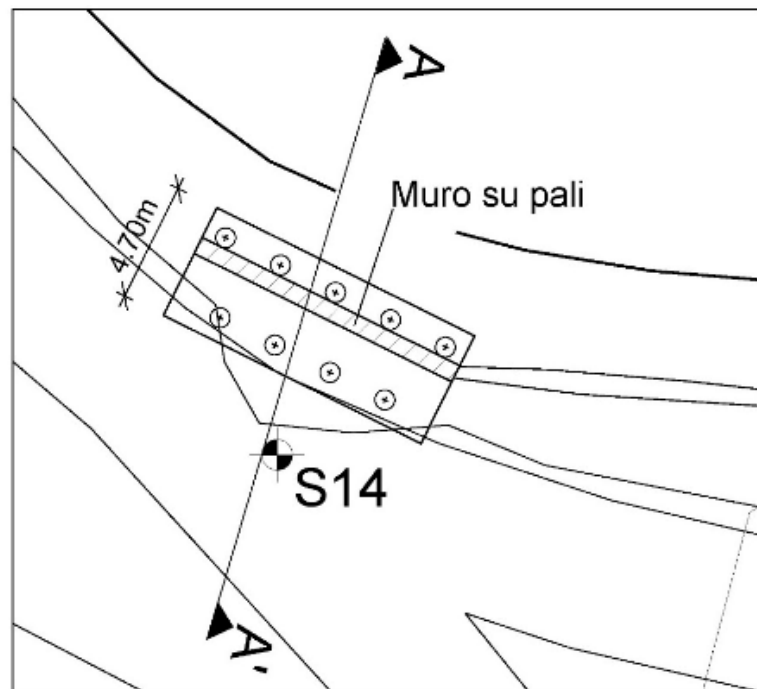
Zona Pietralunga, km 8+700. Planimetria schematica con indicazione del muro su pali. Il rilievo topografico è stato eseguito dalla Città Metropolitana di Palermo ed è stato sovrapposto alla Carta Tecnica Regionale.
